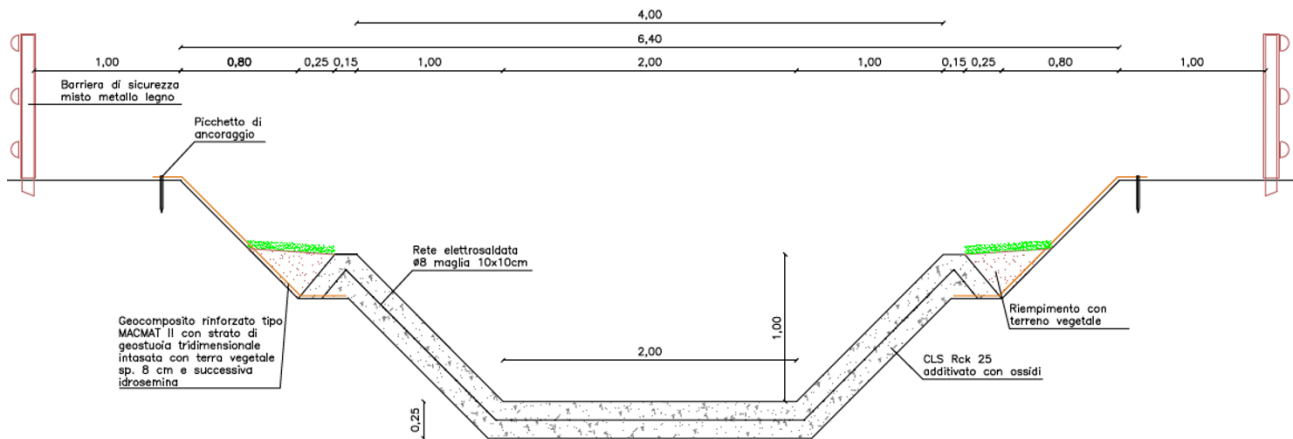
Sezione tipo tratto 5 del canale Baragge
